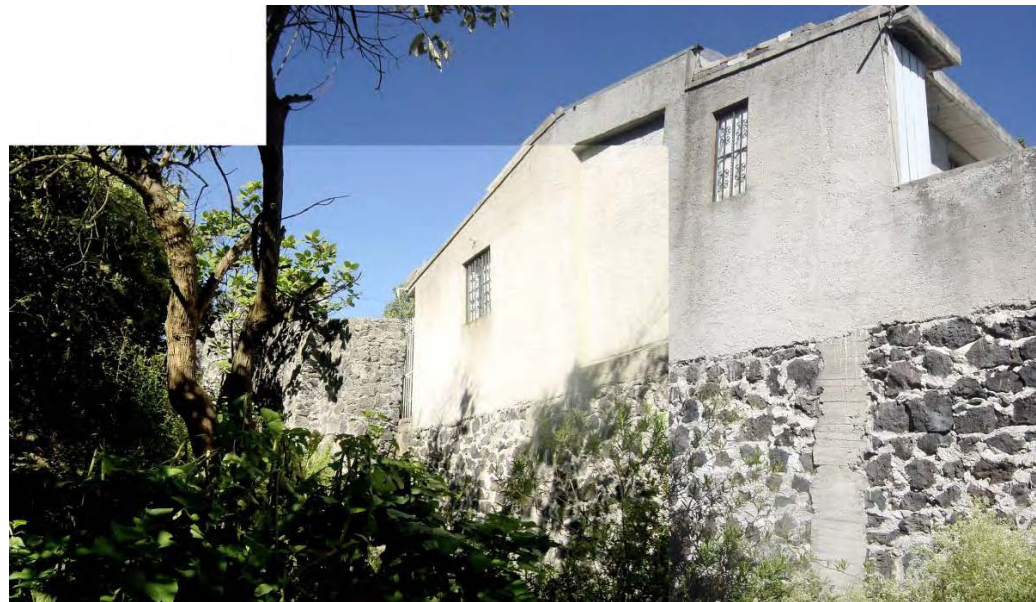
Borde noreste. (Ver plano vista esc:1:5000 Foto 25.)
